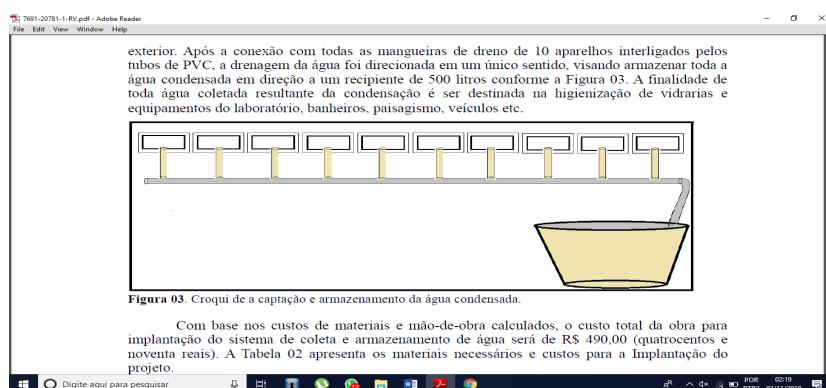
Croqui de a captação e armazenamento da água condensada proposto por Pegoretti et al. (2016)
